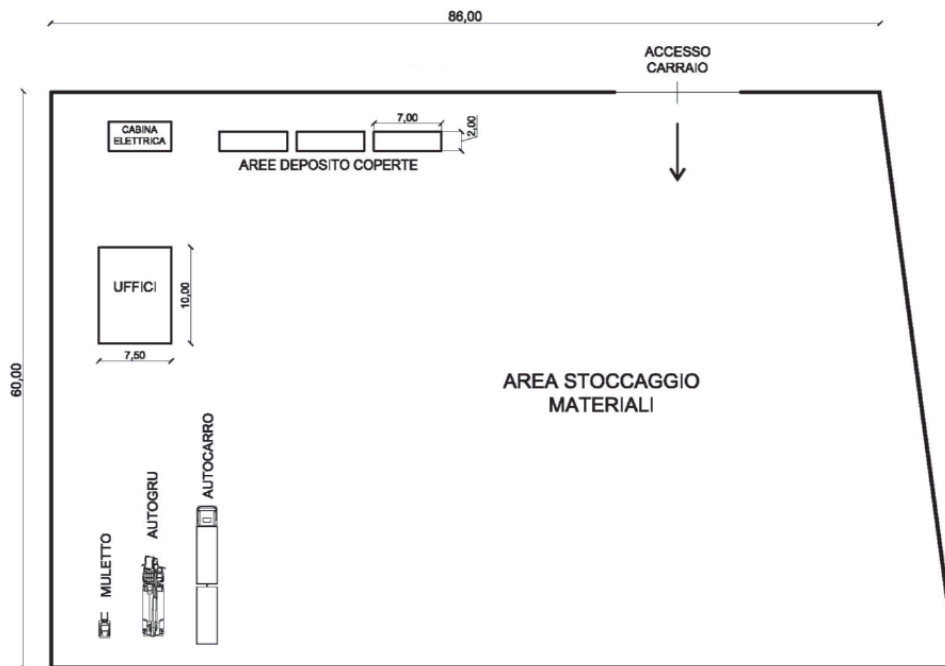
Planimetria di cantiere base "tipo" (le dimensioni riportate sono del tutto indicative)
